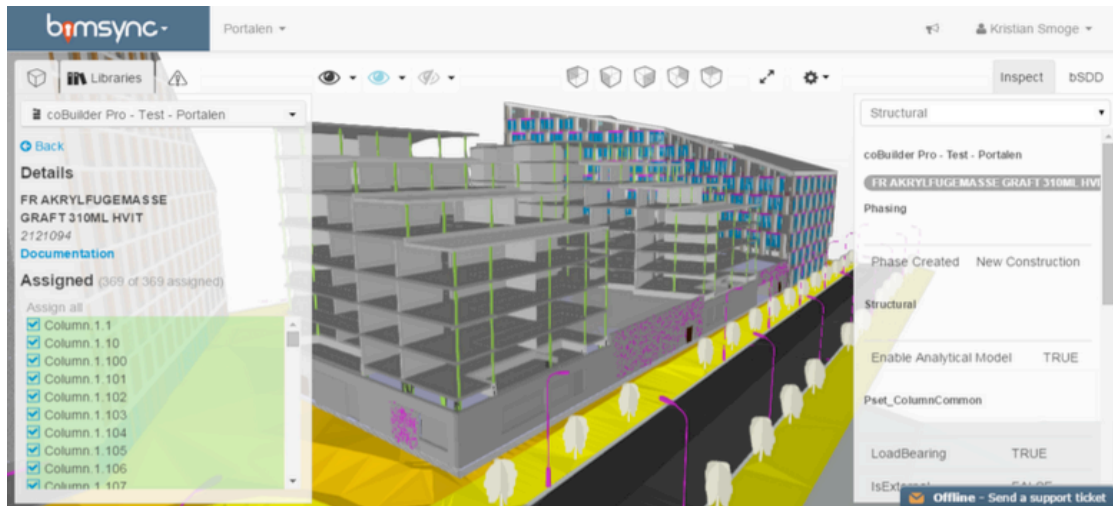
viser de fire byggene: BREEAM-kontorbygget til høyre, de to boligblokkene og næring i midten, samt hotellet til venstre i bildet. I Figur 40 er alle importerte BIM-modeller skrudd på.
